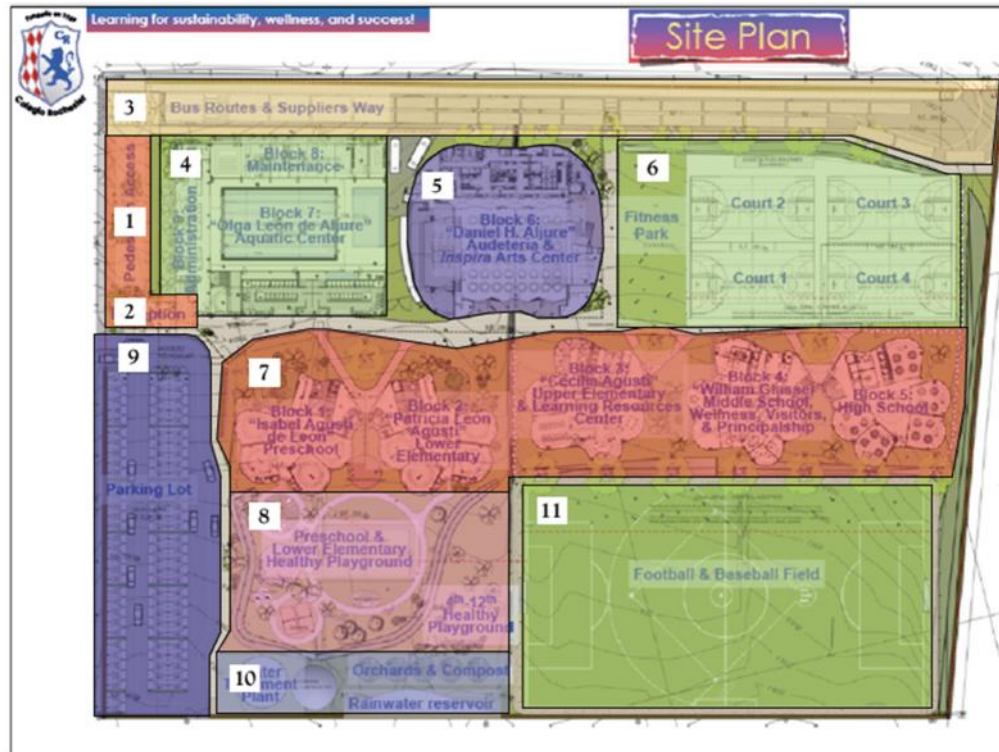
Zonificación planta general y Adaptada de Planta de Emplazamiento.
